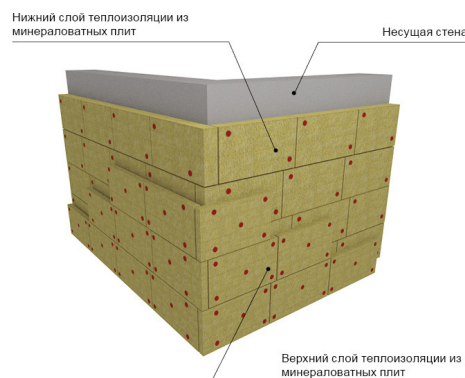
Схема правильной установки теплоизоляции в угловых зонах фасада
